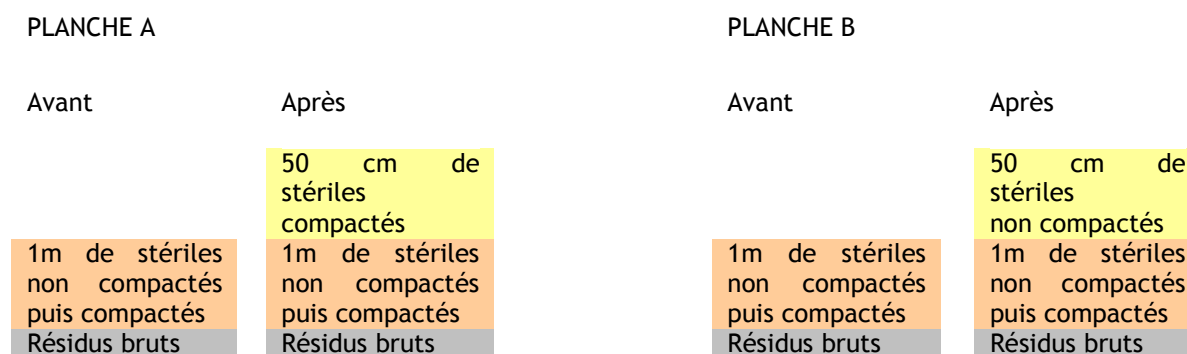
Description schématique des planches d'essai A et B (d'après Algade, 1992)
